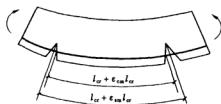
裂缝处混凝土与钢筋的伸长量
